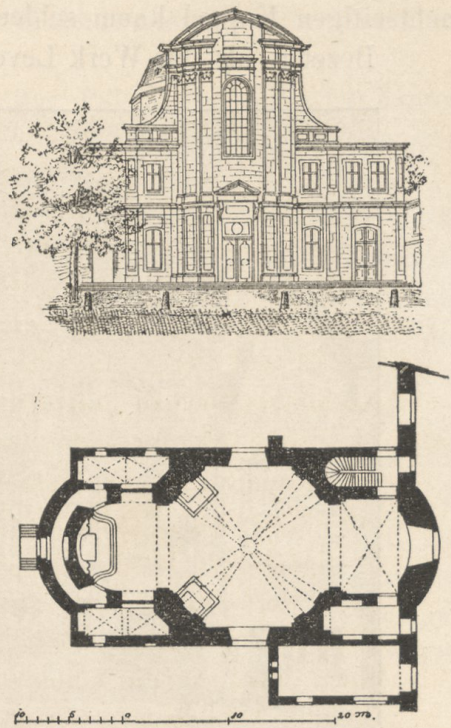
Bonn, Stiftskirche St. Maria in Dietkirchen. Ansicht u. Grundriss.
